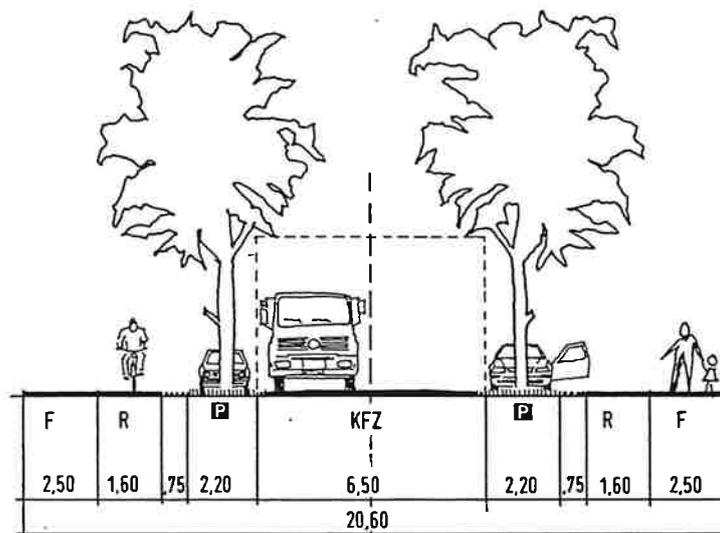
HAUPTSAMMELSTRASSE, ERNST-SCHNELLER-STRASSE, A₅-A₅
